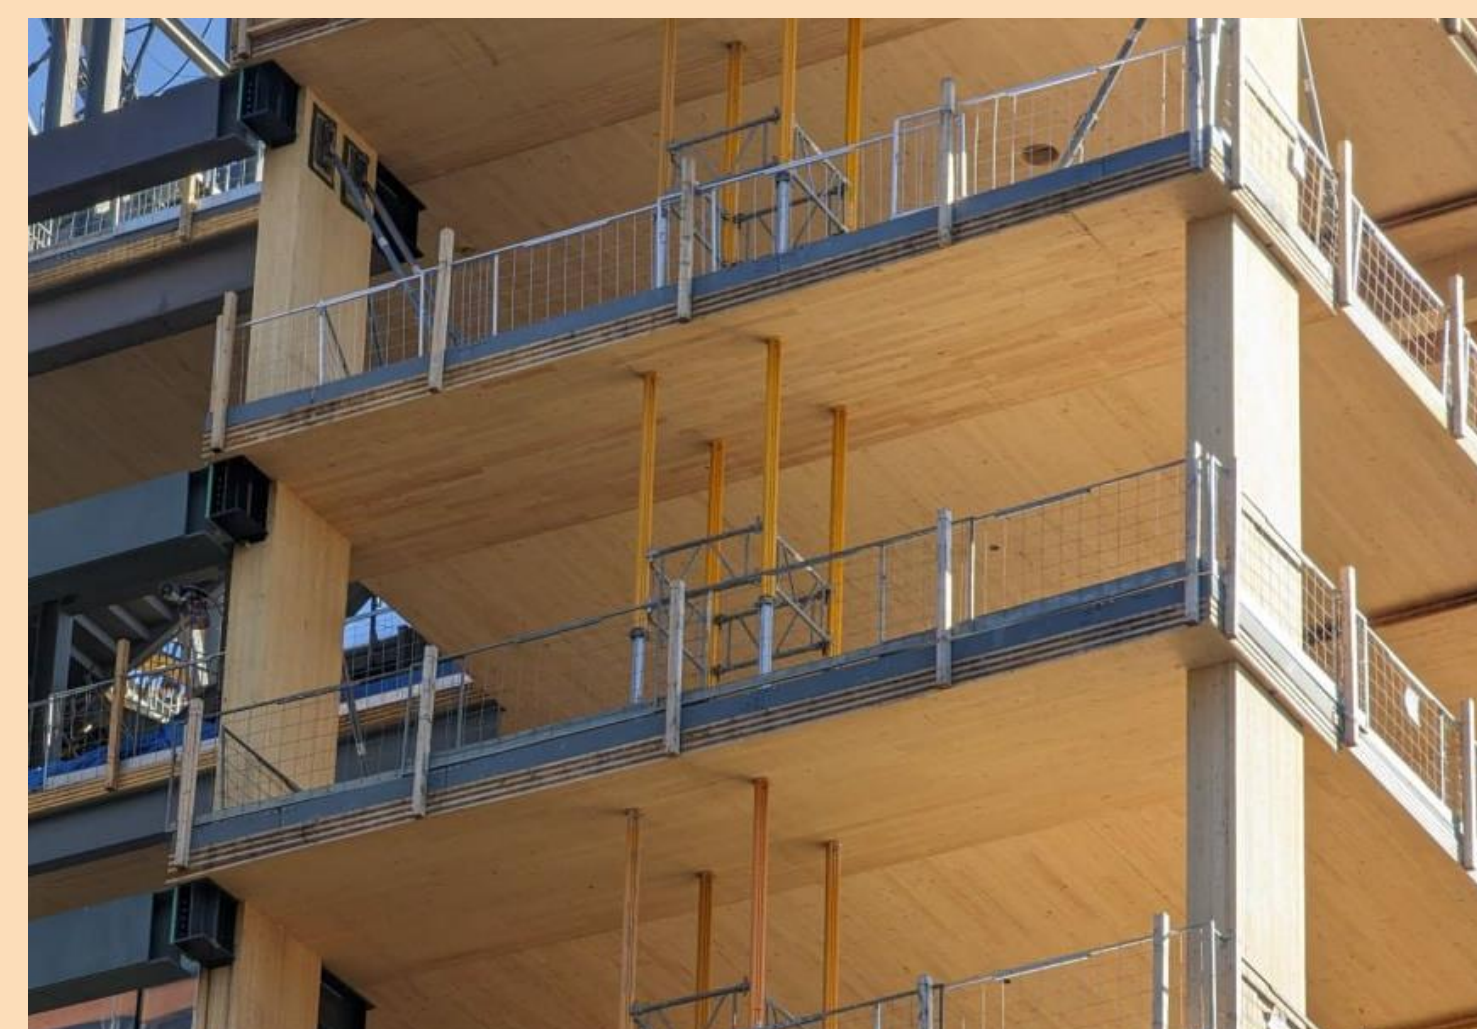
Пример применения деревобетонных плит перекрытия при возведении зданий. Фотография с площадки строительства объекта Limberlost Place в Канаде
